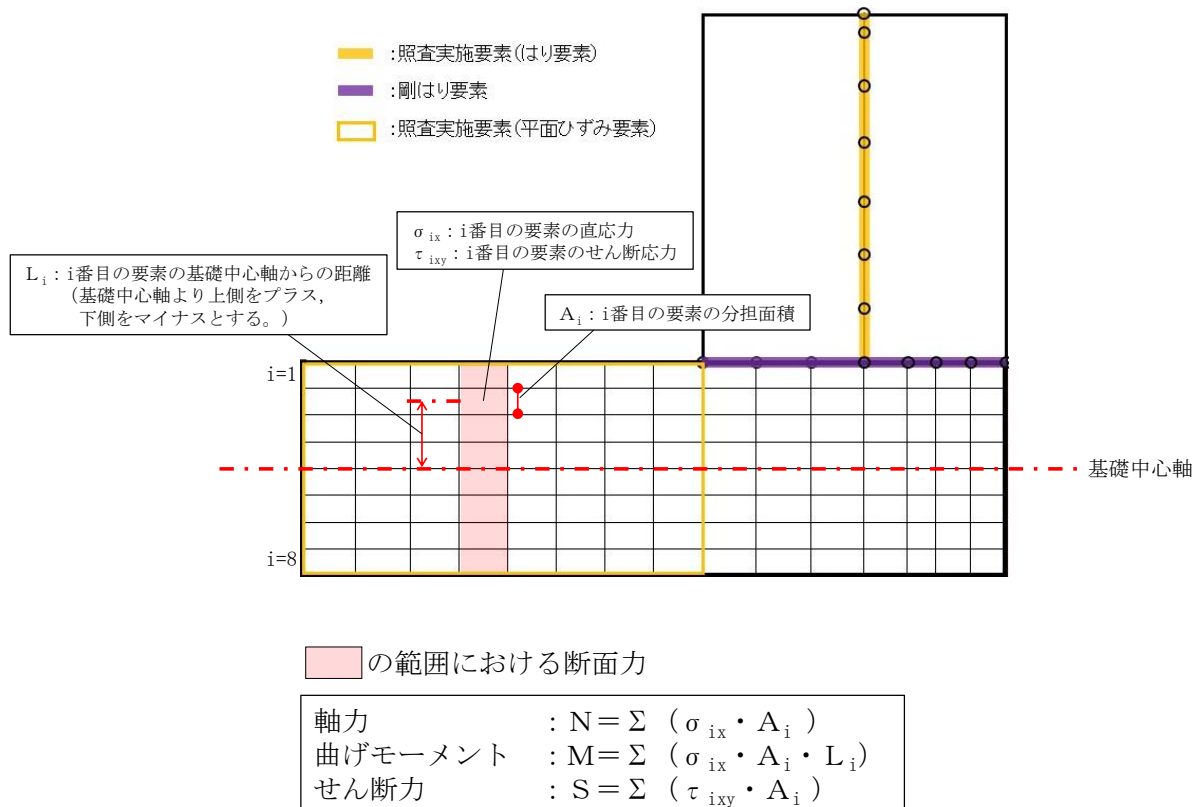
漂流物対策工基礎スラブの断面力算定方法
